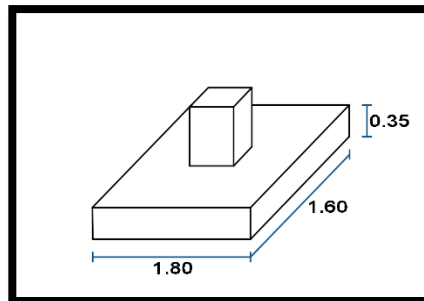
Dimensiones de zapatas centrales exteriores. Fuente: Elaboración propia.
